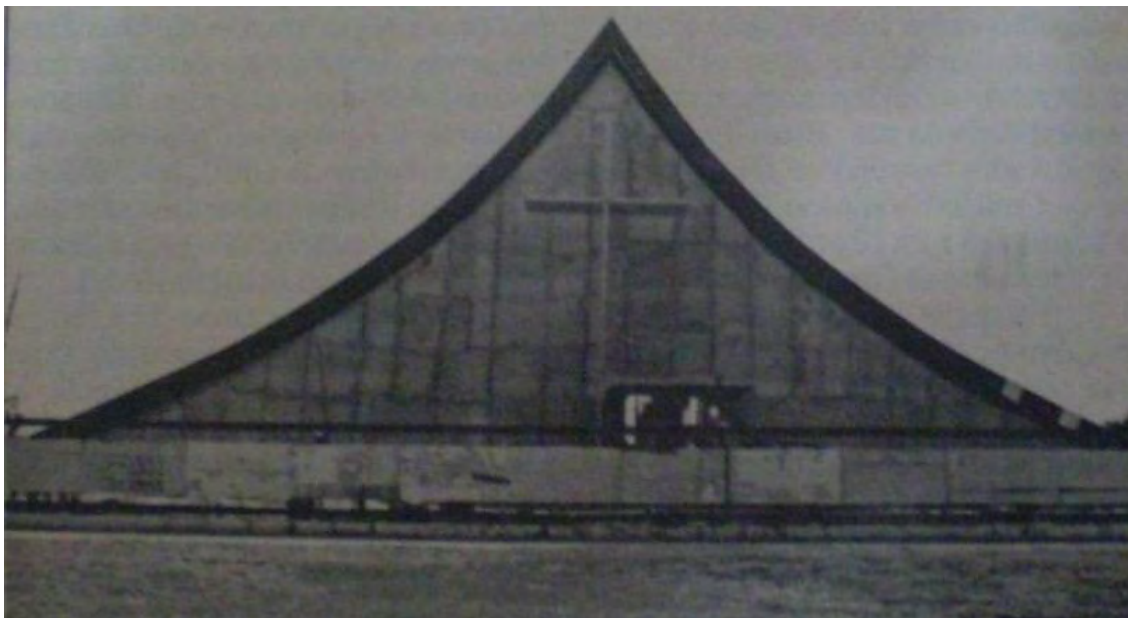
Foto da Construção da Catedral Rainha da Paz.
